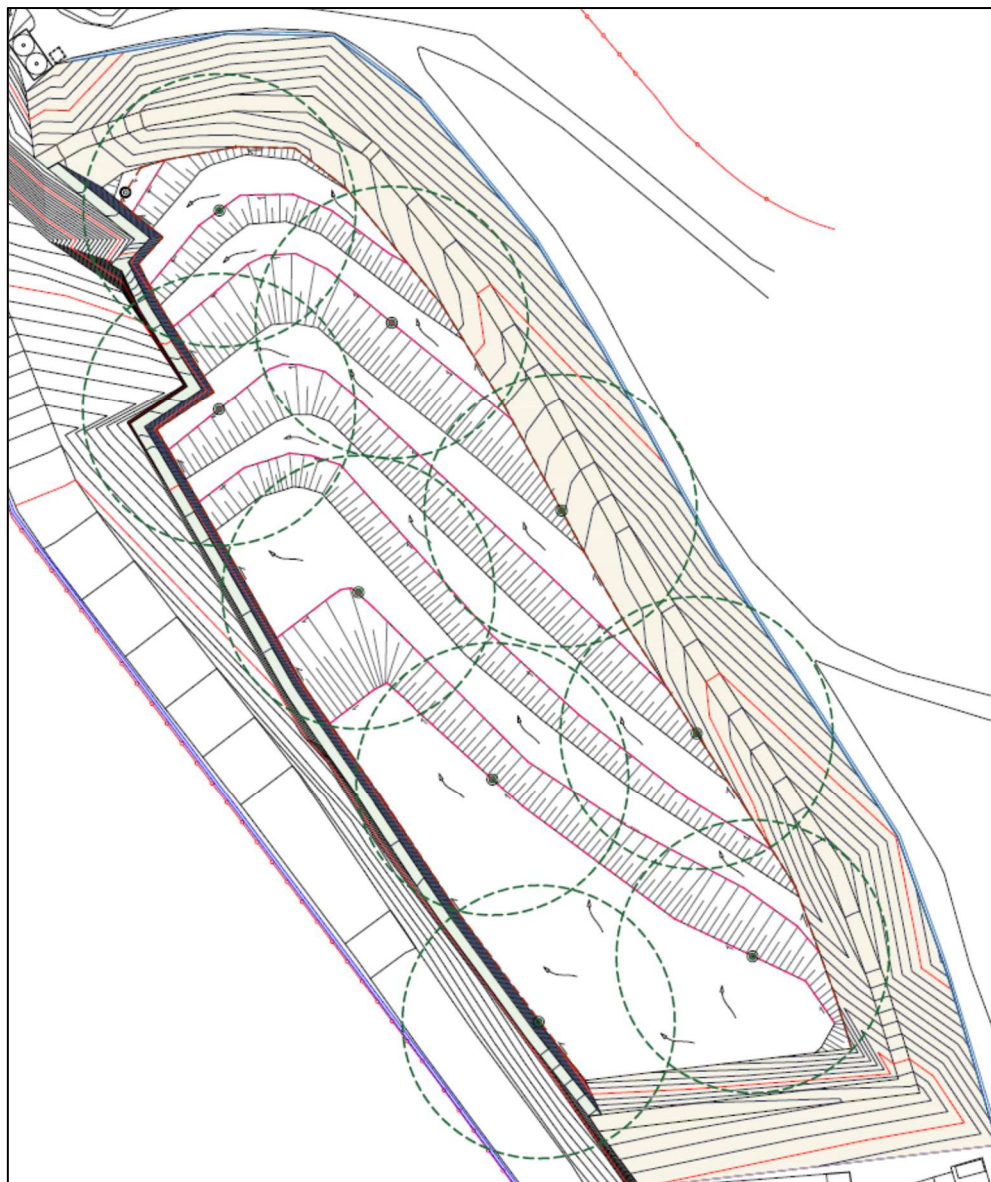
/XXV: Distribuzione planimetrica dei pozzi di biogas
